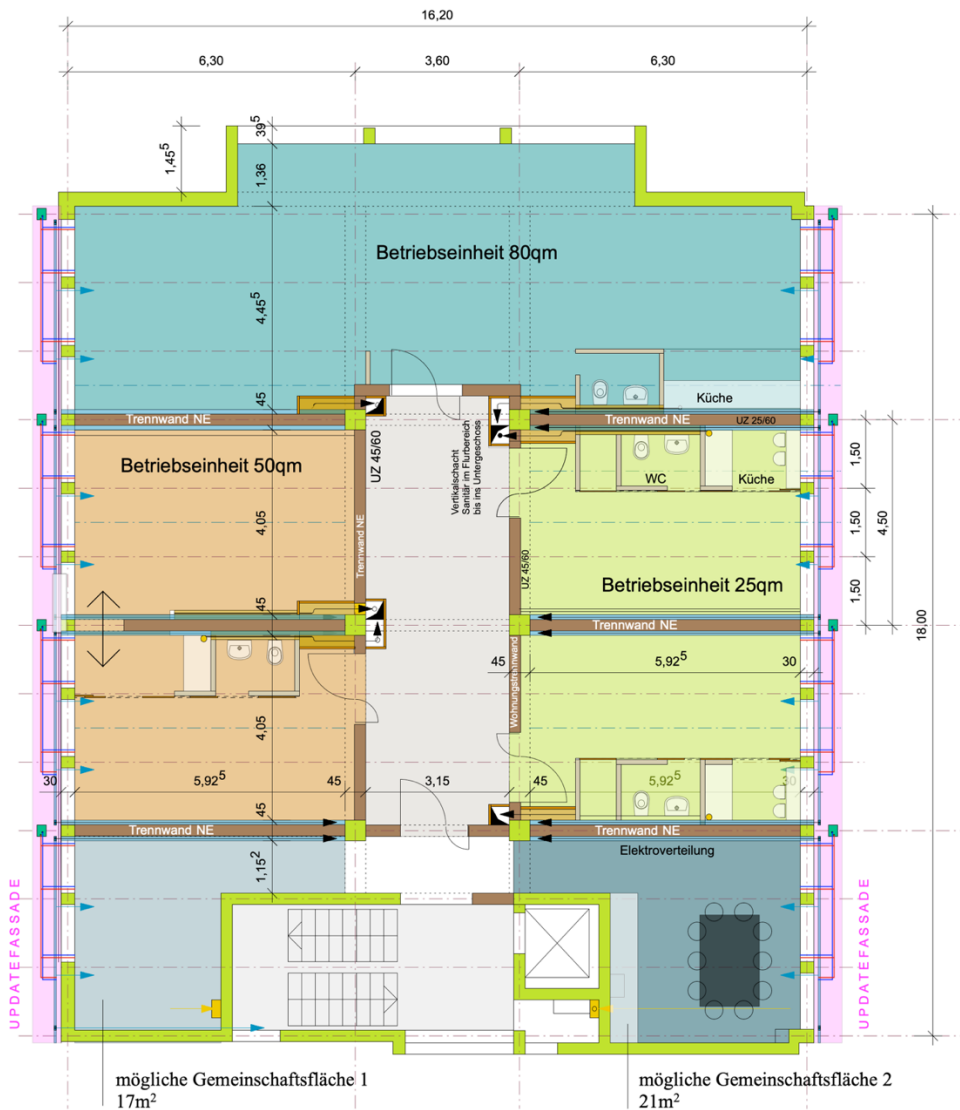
Darstellung Grundriss: mögliche Einteilung von verschiedenen Betriebseinheiten
